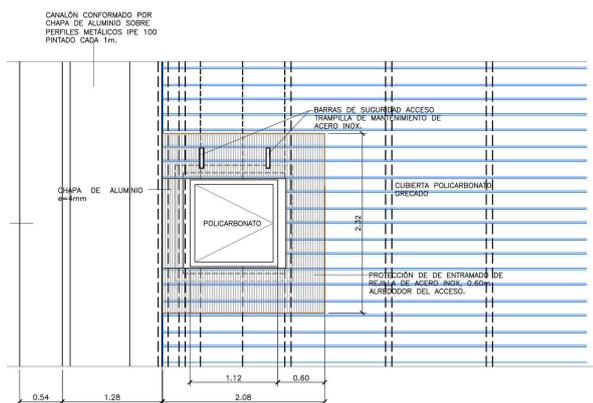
Vista en planta de las trampillas de acceso a la cubierta. Fuente: elaboración propia.
